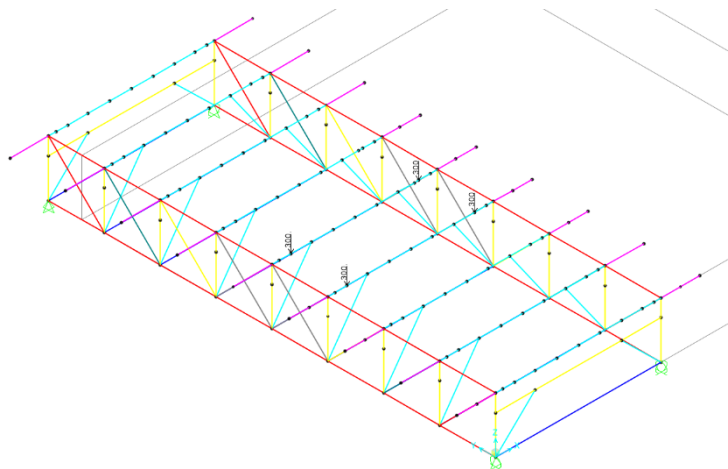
Modelo SAP2000. Grúa en posición de trabajo.
